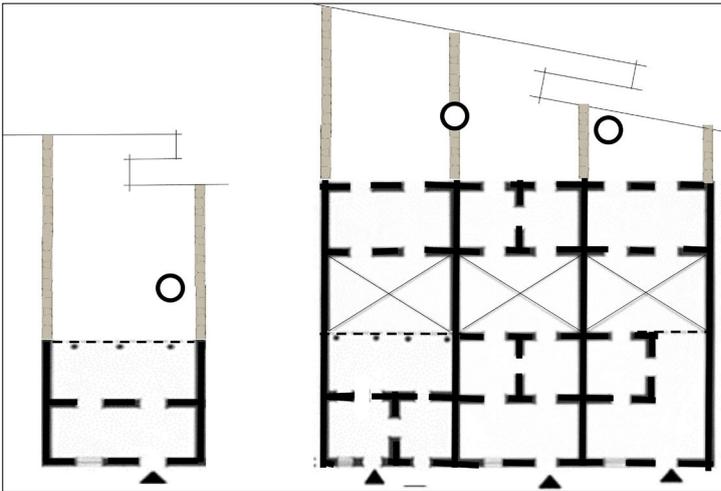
Plantas arquitectónicas de vivienda popular colonial para clase social baja, siglos XVI y XVII.¹⁹⁵
